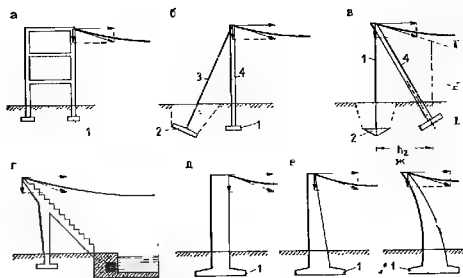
Схемы опорных конструкций висячих покрытий при разомкнутом наружном контуре
